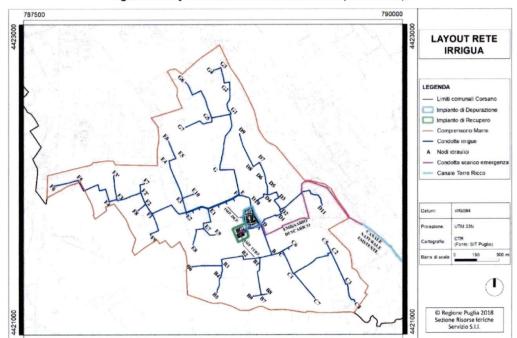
Lay-out della rete di distribuzione (Fonte: T06).
